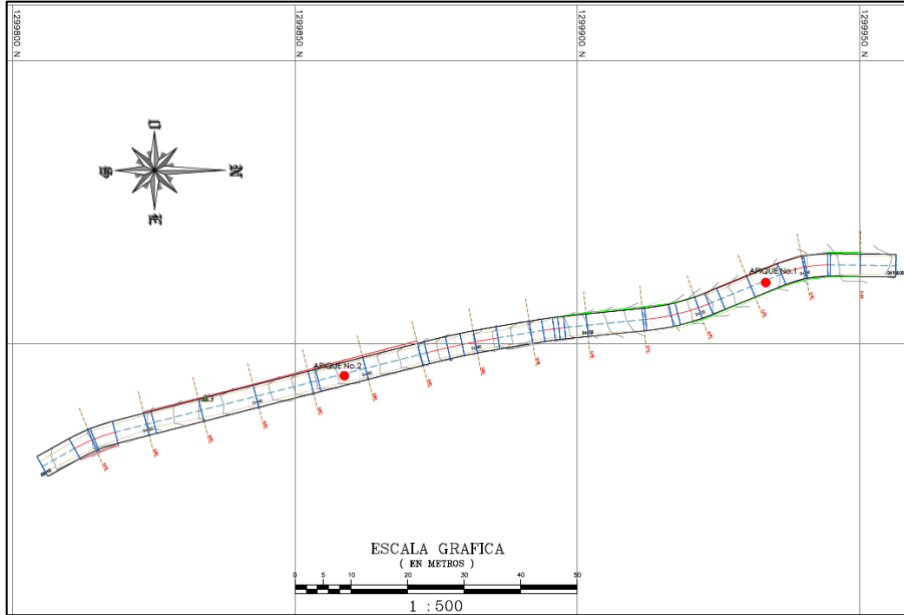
Imagen de planta del tramo 2 del proyecto de Rionegro-Santander
